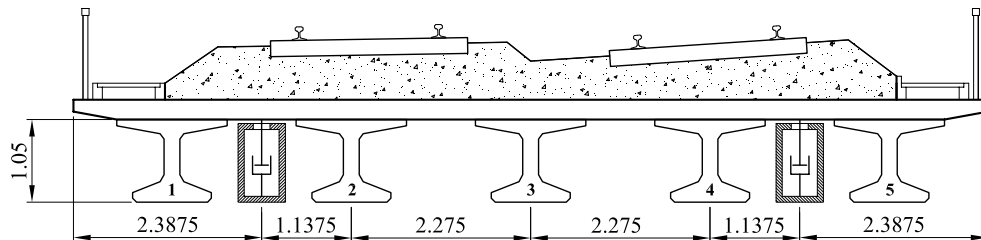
Ubicación de las vigas auxiliares en el puente Arroyo Bracea II
